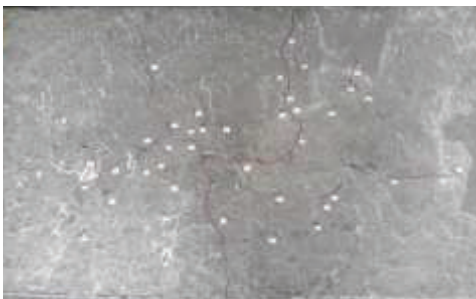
Aspecto de una losa con esquema de fisuración después del tiempo de ensayo.
